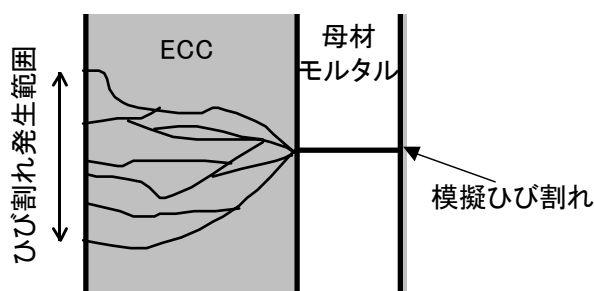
ECC側面のひび割れ図 (case0 終了後)
